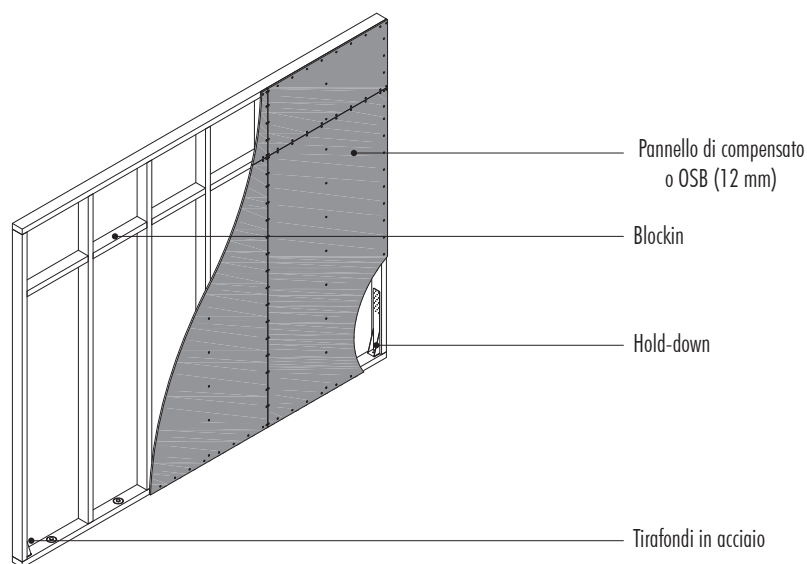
Dettaglio strutturale di una parete Platform con collegamento del pannello strutturale di compensato/OSB tramite chiodi e elementi di collegamento alla fondazione.
